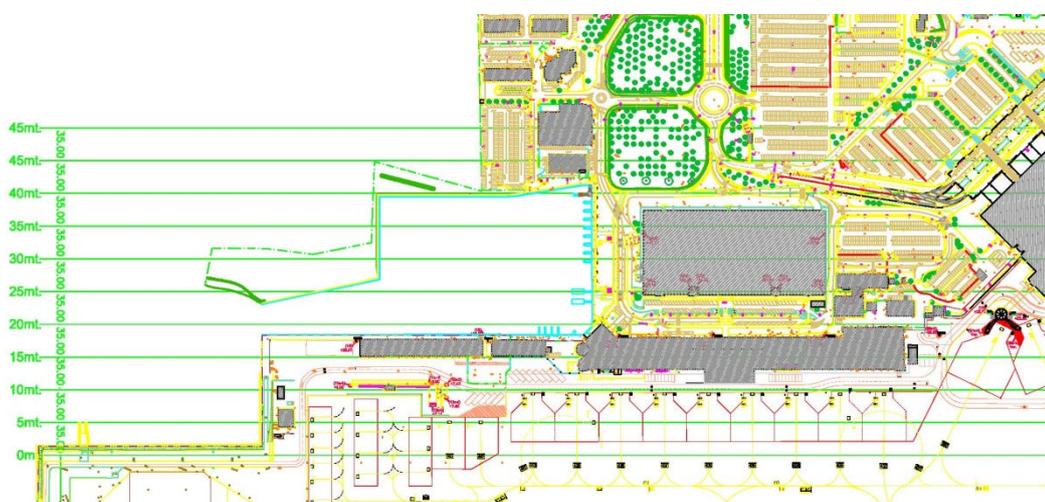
Estratto della planimetria del Piano degli ostacoli
